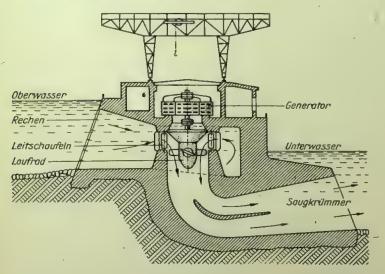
Aufbau eines Wasserkraftwerks nach dem Laufwasserprinzip mit Kaplanturbine
